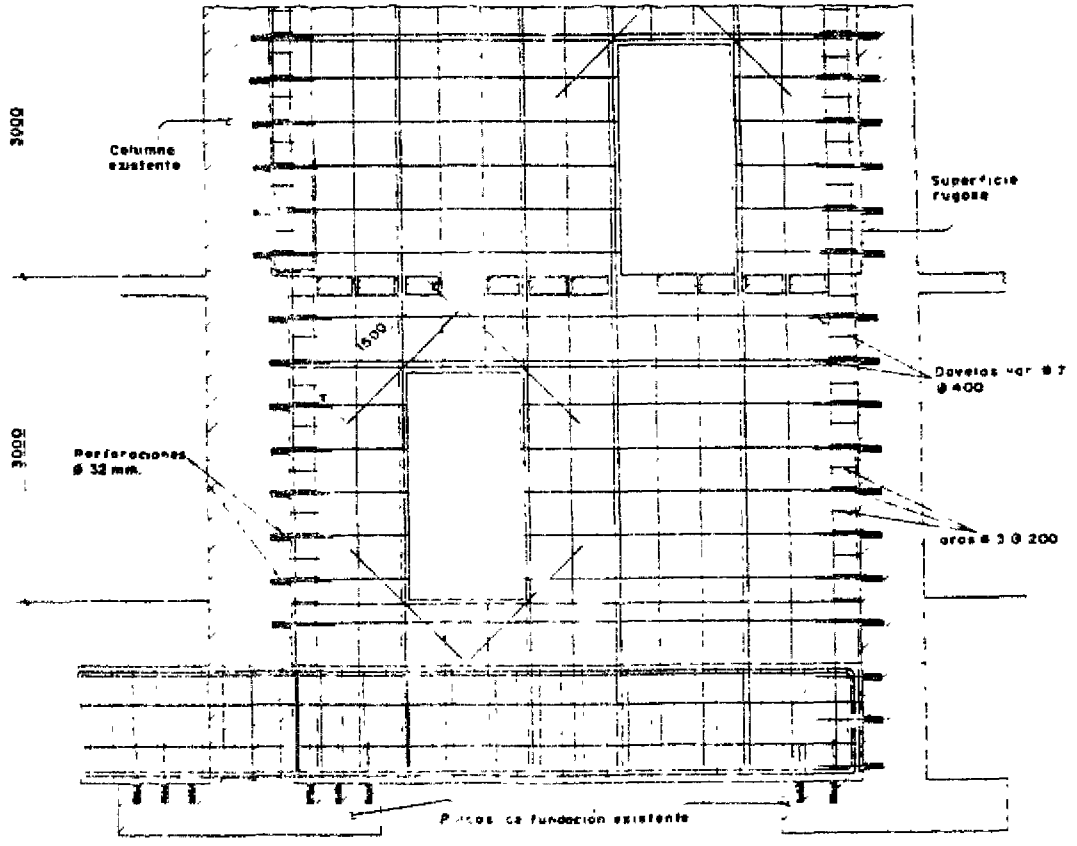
Detalle típico del refuerzo de muros estructurales y de las aperturas para puertas y ventanas.
